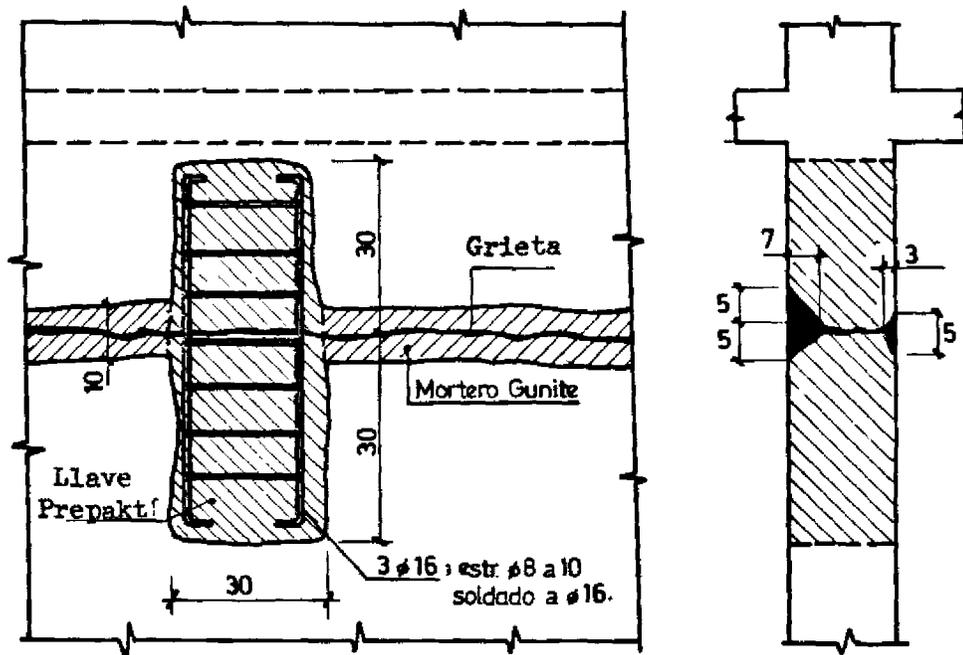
Caso M-2. REPARACION DE UN MURO O PILAR DE HORMIGON ARMADO CON FALLA EN JUNTA DE HORMIGONADO (llaves Prepakt)
